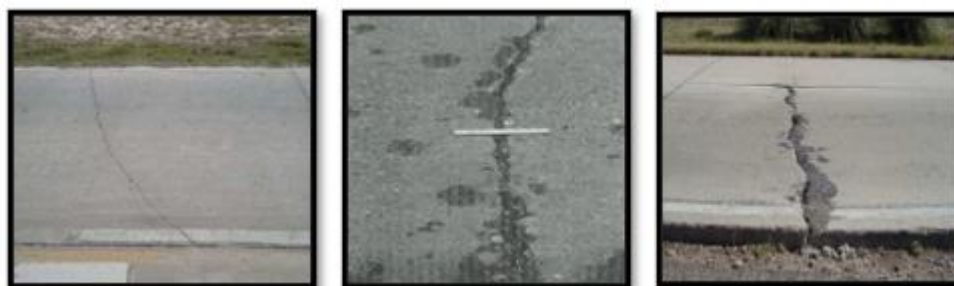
Falla tipo grietas lineales de severidad baja, media, alta.
